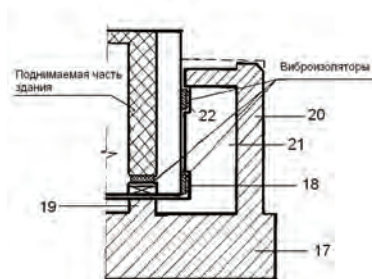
Схема виброизоляции цокольного этажа в основании здания.
